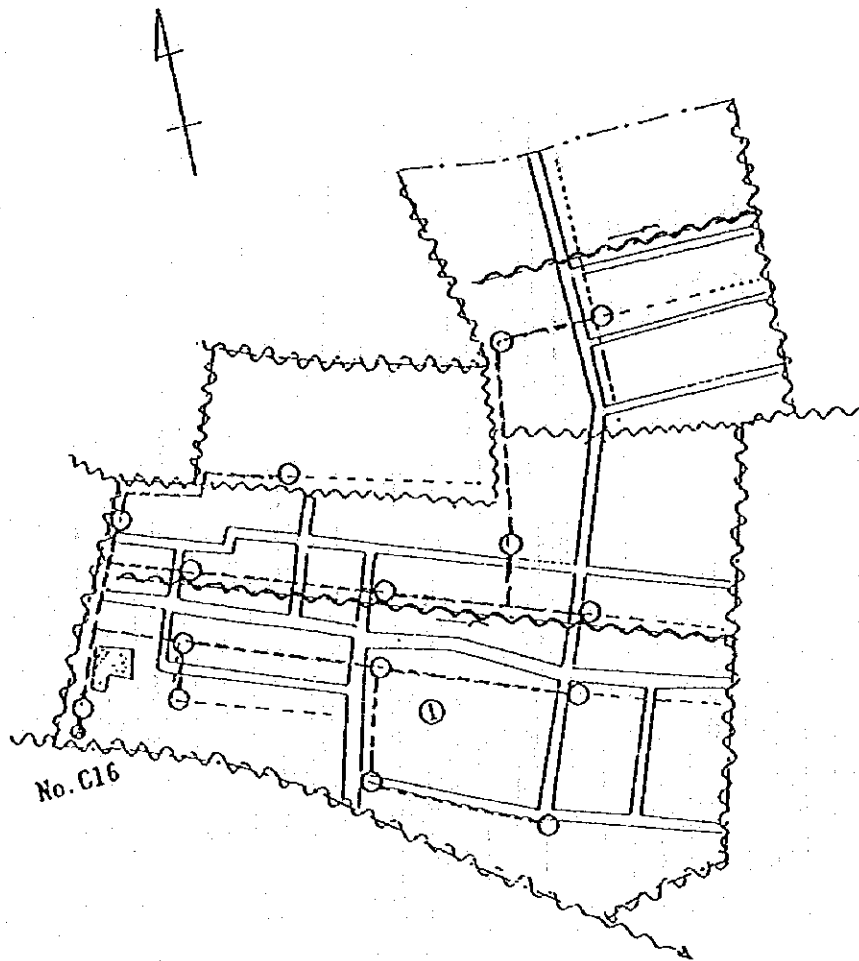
Plan horizontal du projet des installations terminales (Draa Sud)
